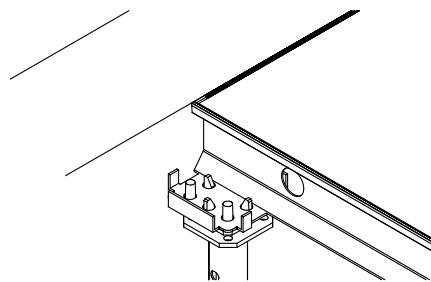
с насадной оголовка в углу, оголовка возле стены
